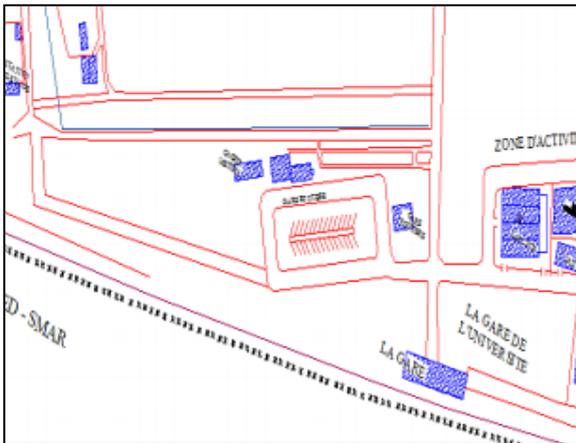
Vue en plan de la gare avant l'intervention (gare ferroviaire)
